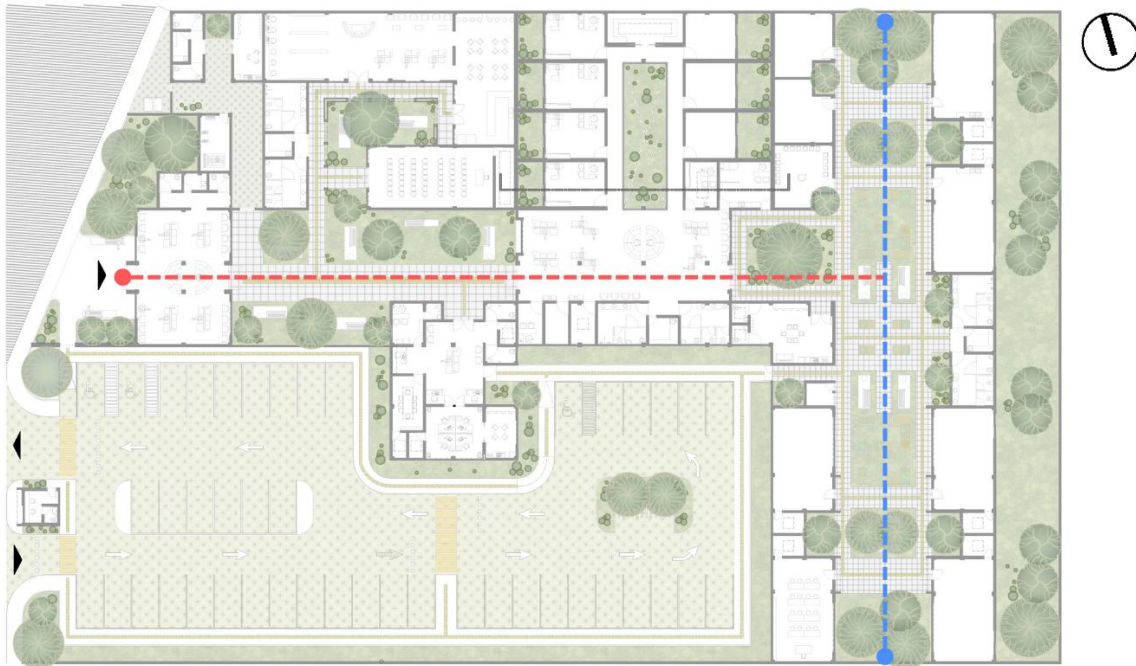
Planta arquitectónica con ejes de composición: eje principal (rojo) y eje secundario (azul).
